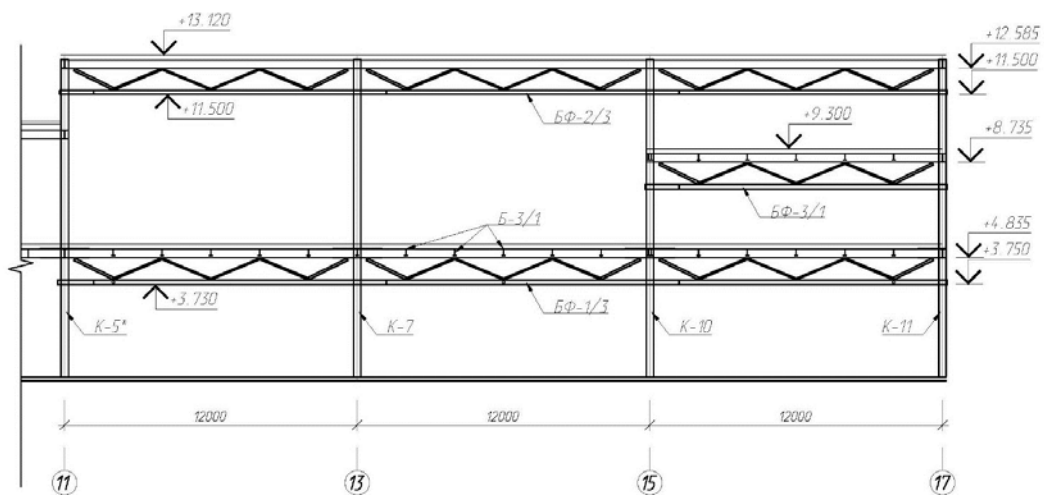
Сталезалізобетонне перекриття, прольотом 12 м
